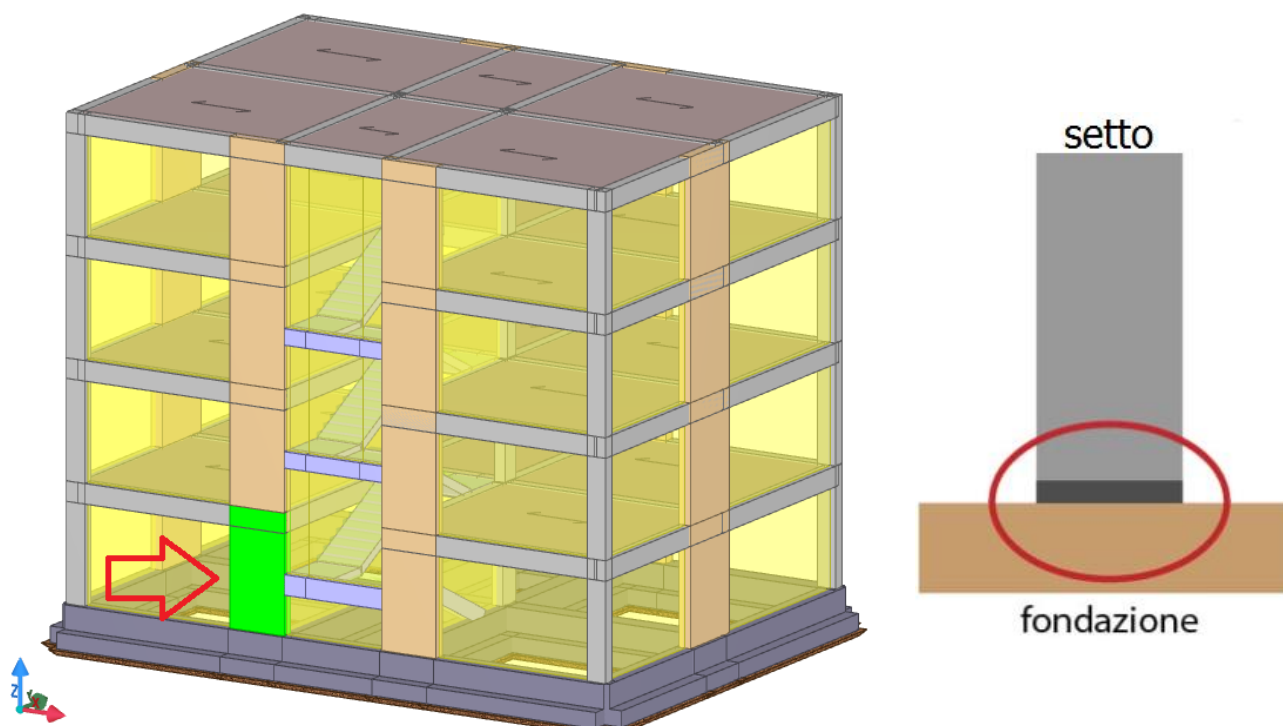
Vista 3D - pilastro oggetto di verifica
